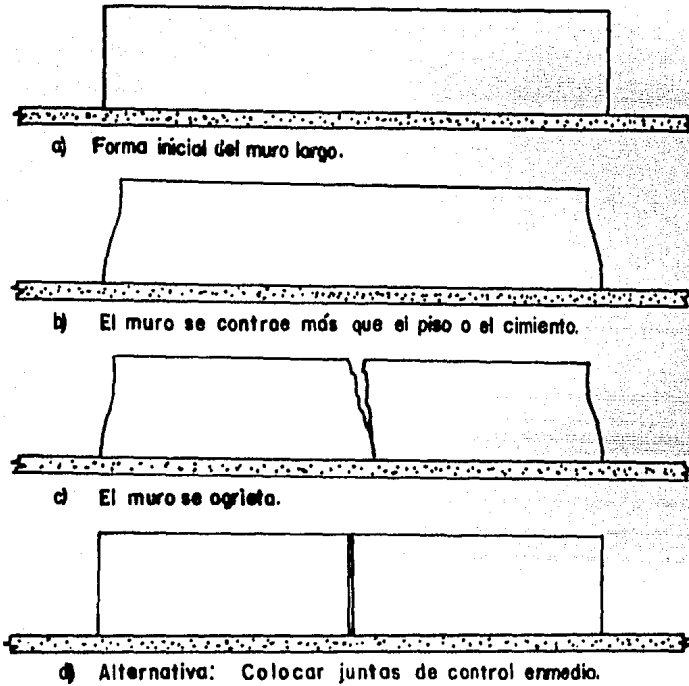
Agrietamiento de un muro largo ocasionado por la contracción.
